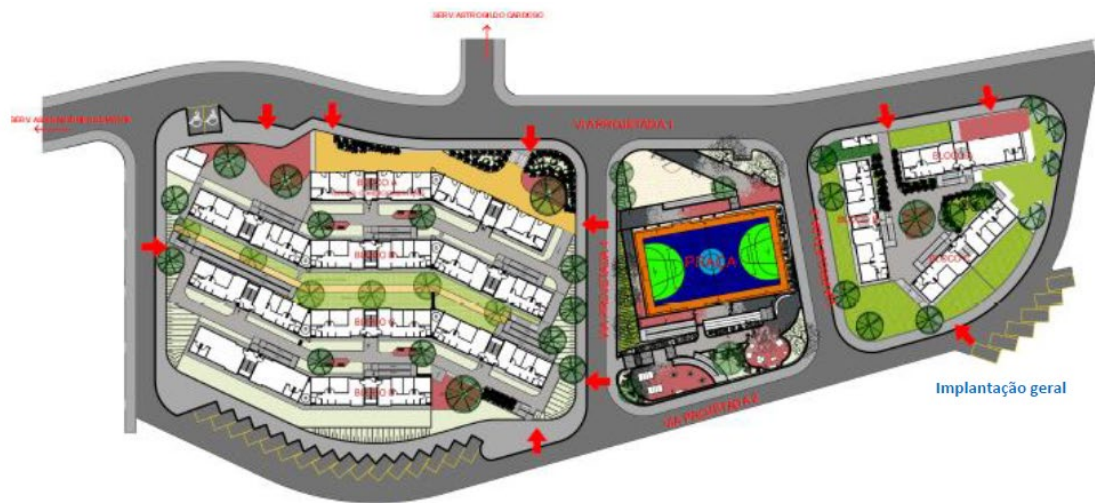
Área prevista para implantação do projeto Morro do Horácio
